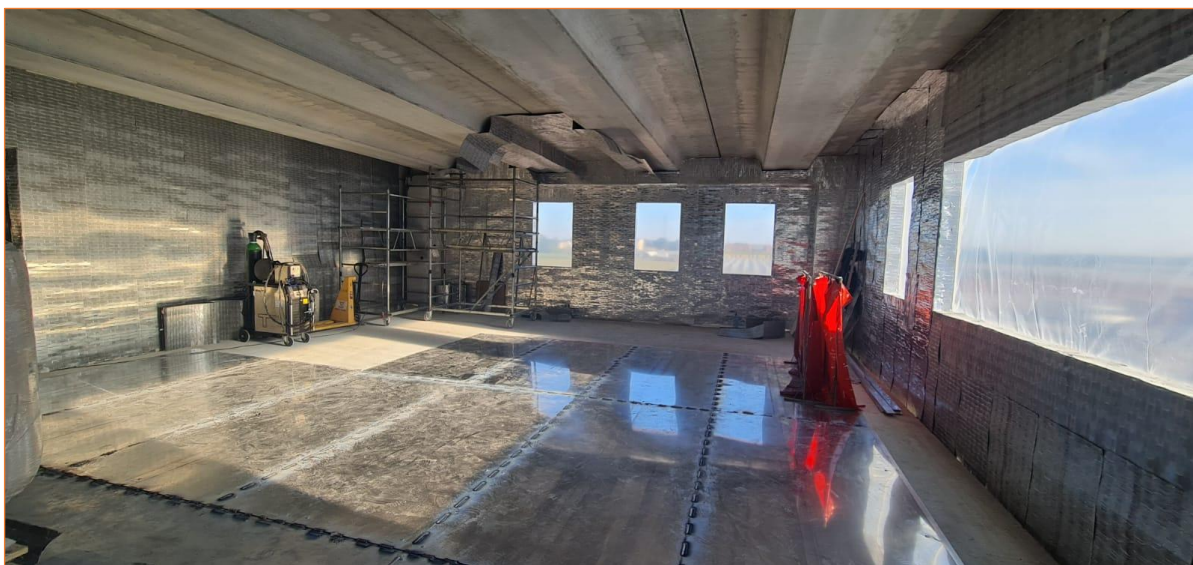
Sistema G-iron AFH™ su pavimento e pareti
